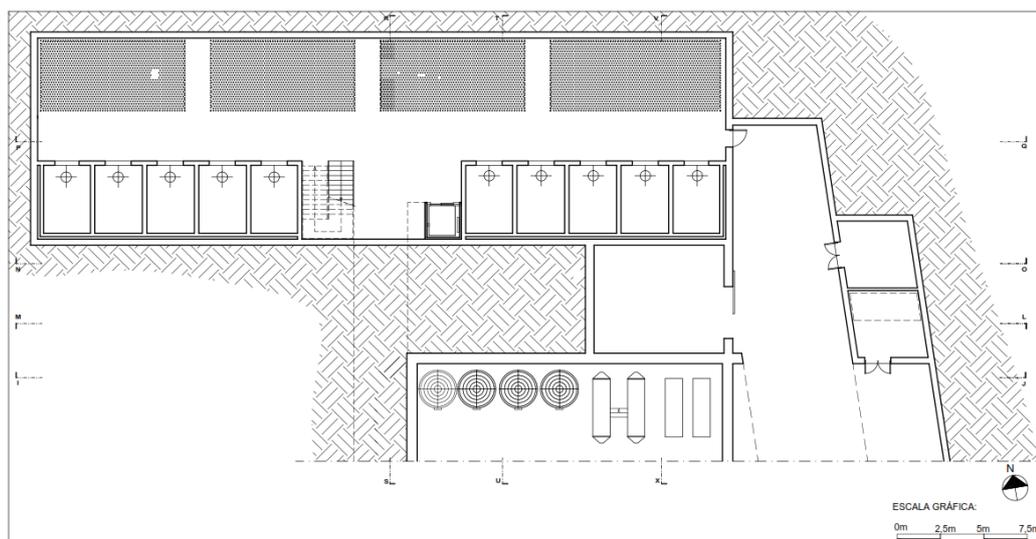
Planta da Semi-cave do Museu e zona de equipamento de apoio à adega⁸⁸
